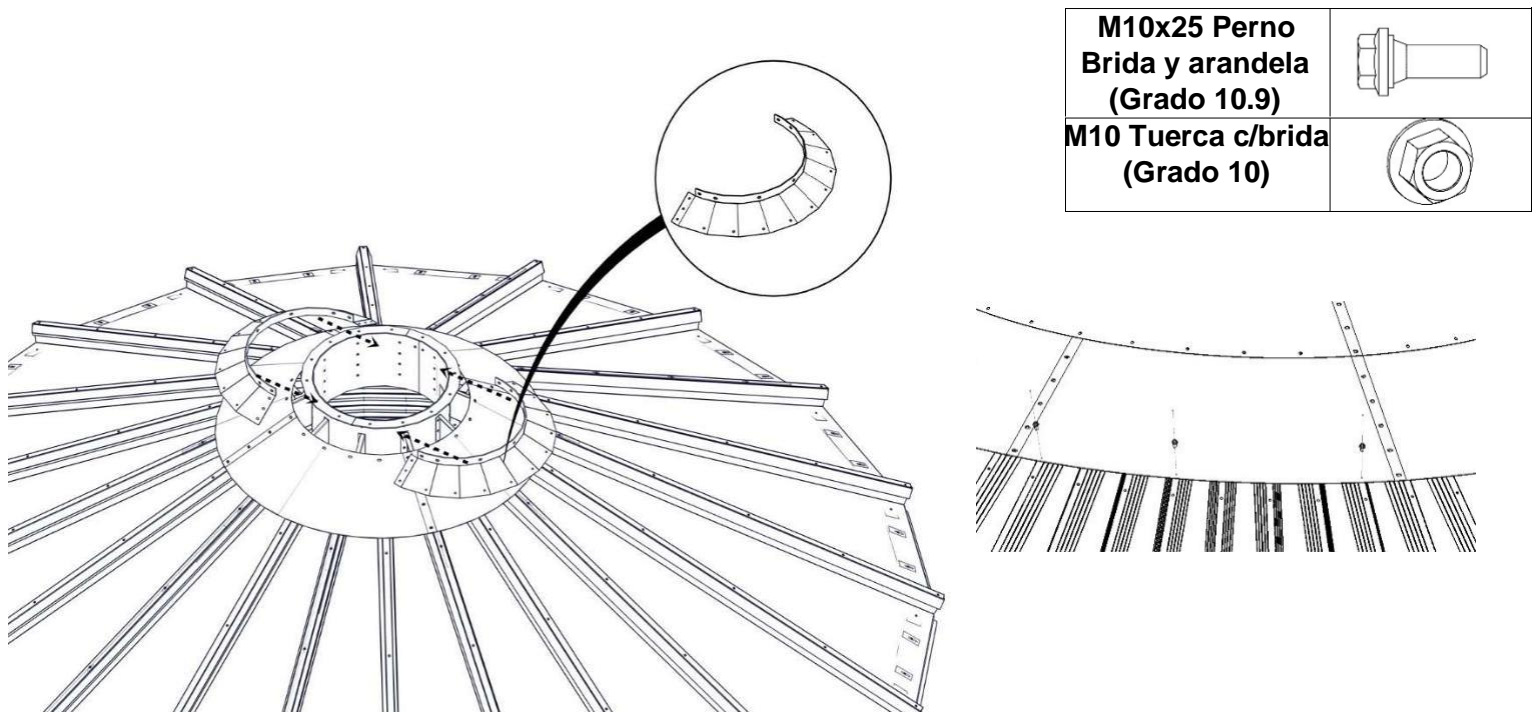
Instalación Tapajuntas de Pico de Techo
